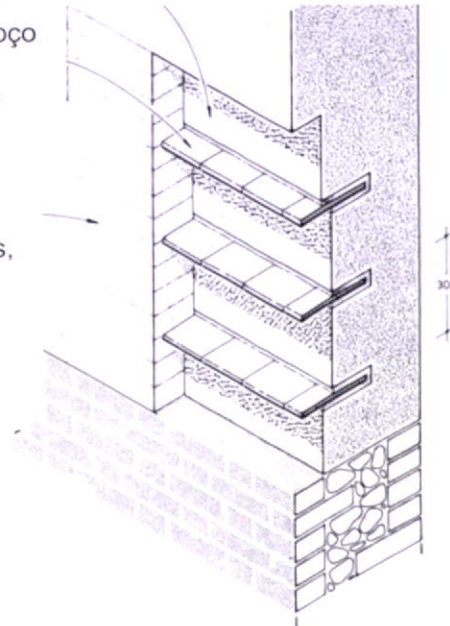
Pormenor construtivo do preenchimento de lacunas de grande dimensão, usando tijoleiras como ligação entre a estrutura origina e o novo pano de adobe.
